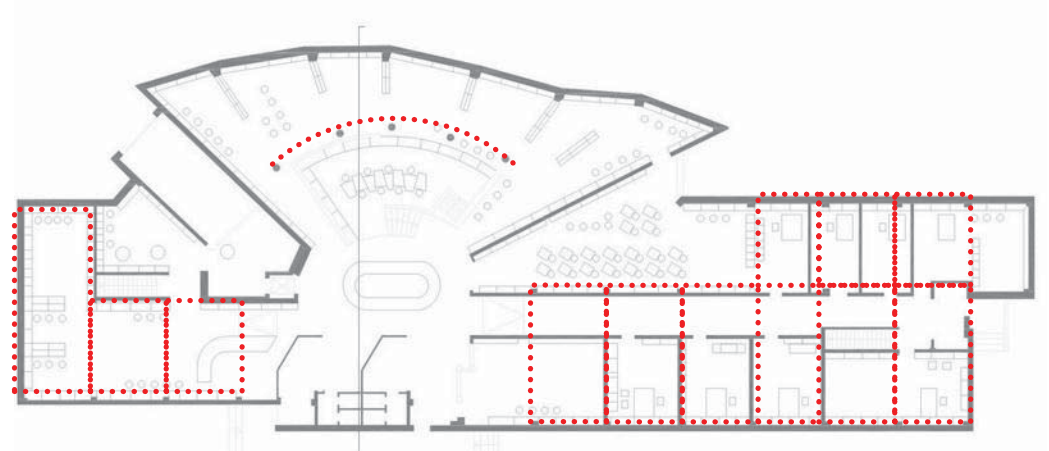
Planta baja, muestra la distribución de las columnas redondas y cuadradas alineadas en forma circular y reticular.
